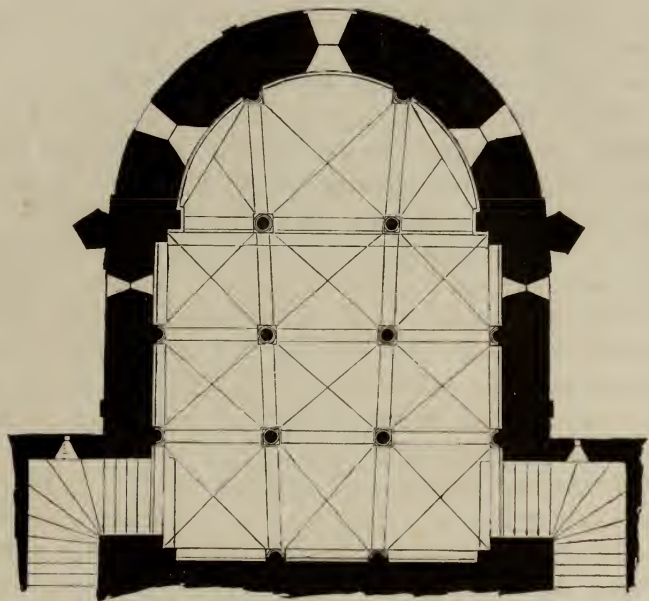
Grundriß der Krypta der Kirche zu Laach.
